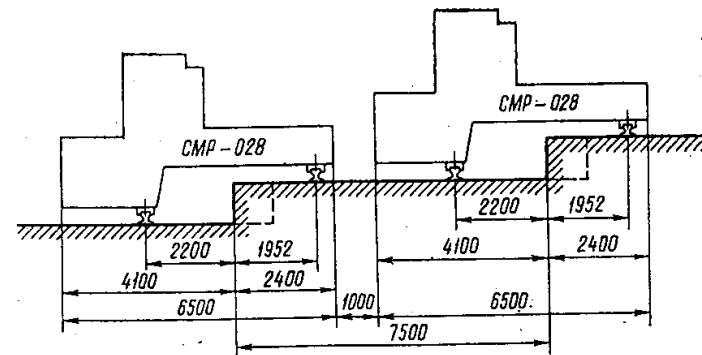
Схема к расчету минимальной ширины рабочей площадки на подступе при работе камнерезных машин СМР-028
